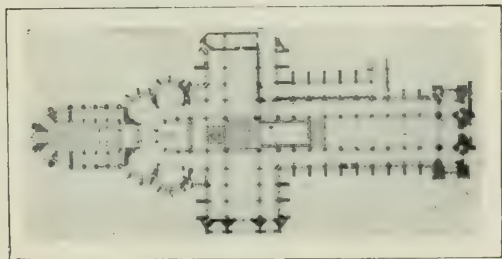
ABBAYE DE WESTMINSTER : PLAN.
